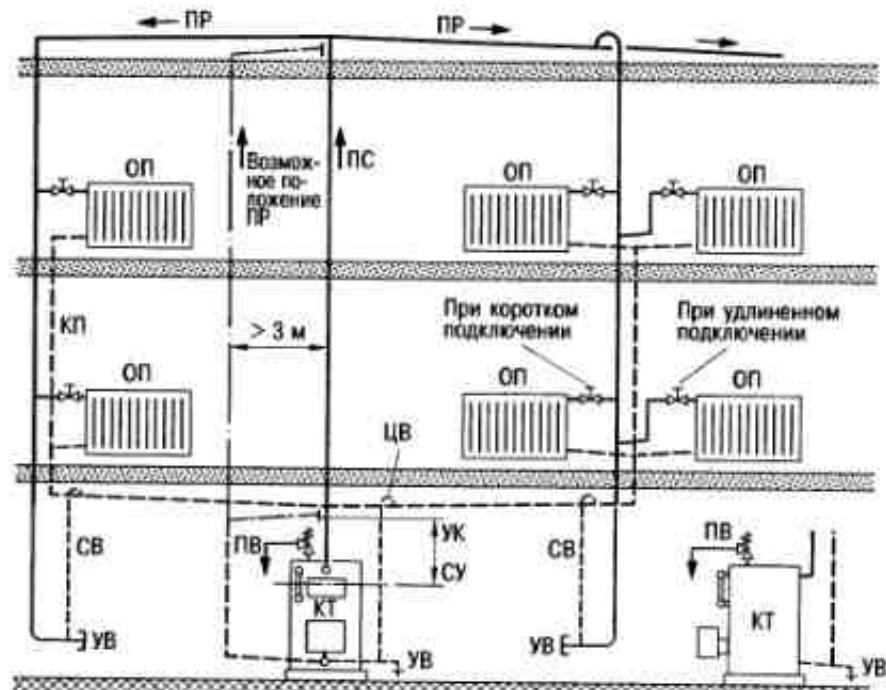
Верхняя разводка с сухим конденсатопроводом [4.1].
